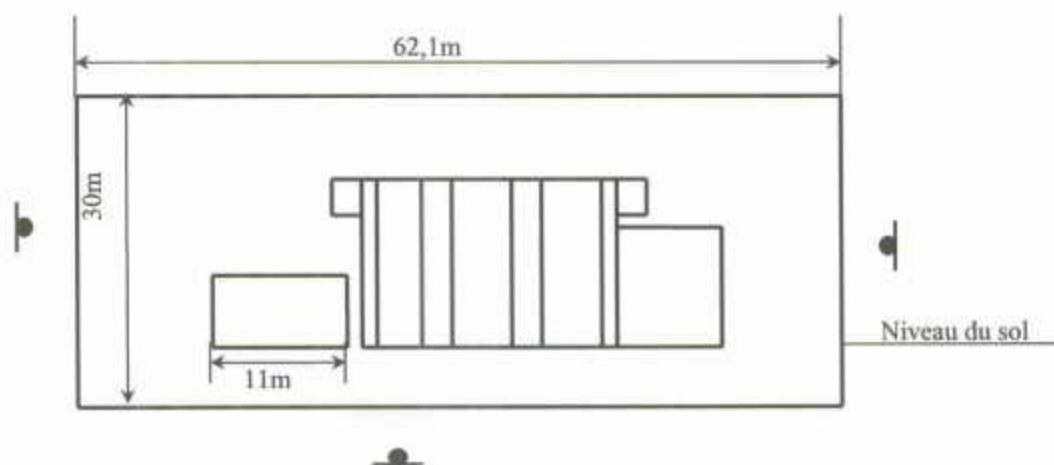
Géométrie de la section 3D : coupe longitudinale (salle des sarcophages et piliers)
